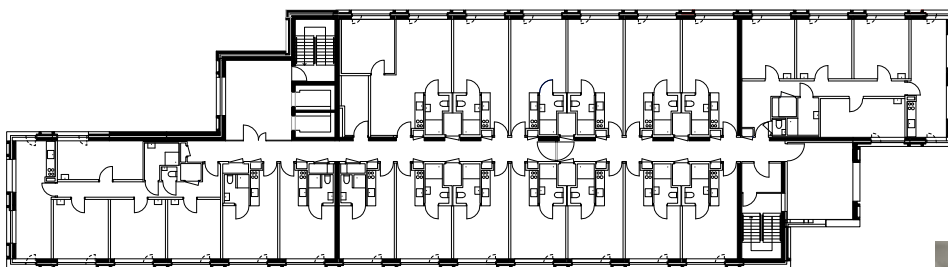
Grundriss Regelgeschoss, M. 1:500 [© BF Vario]
